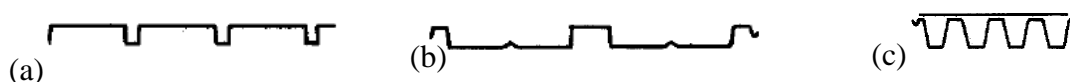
(a) Painéis para cobertura, (b) Painéis para fachada e (c) Painéis laje mista (adaptado de Yu, 2000).
